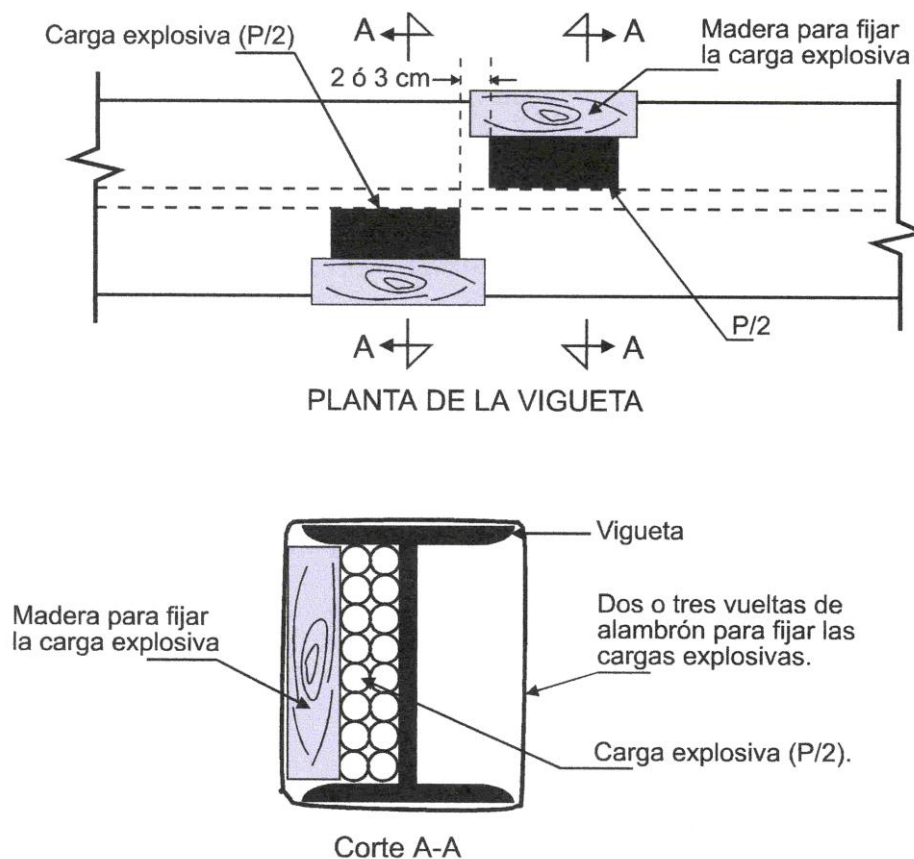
Forma recomendable de fijar el explosivos en un perfil estructural metálico.
